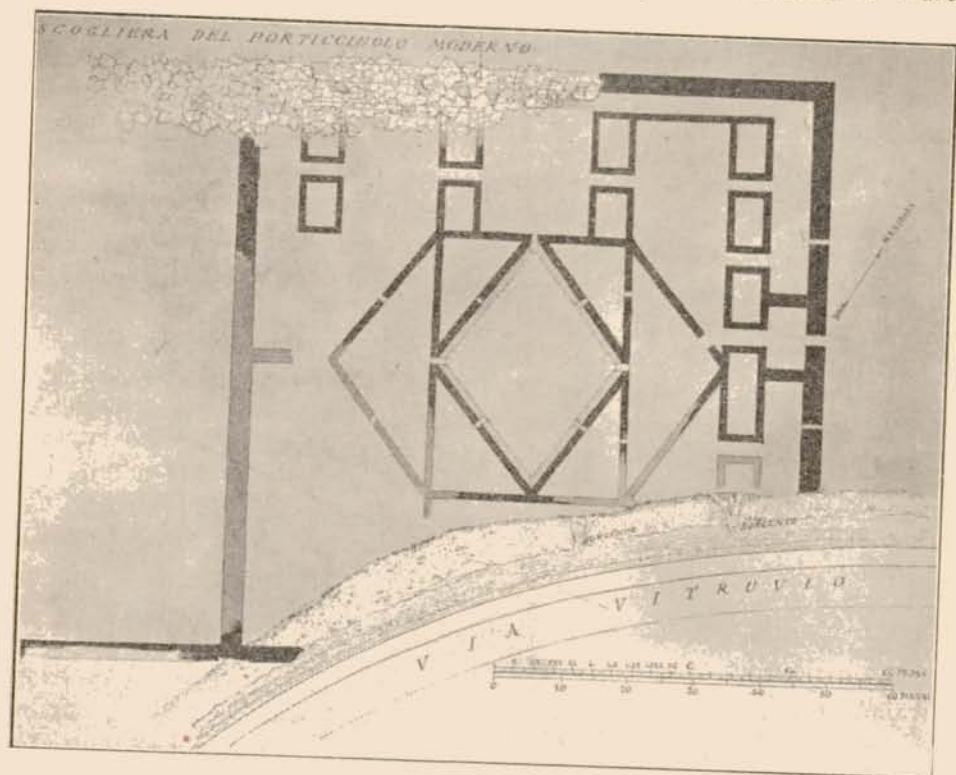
Piscina a Formia. Rilievo planimetrico dell'autore.
